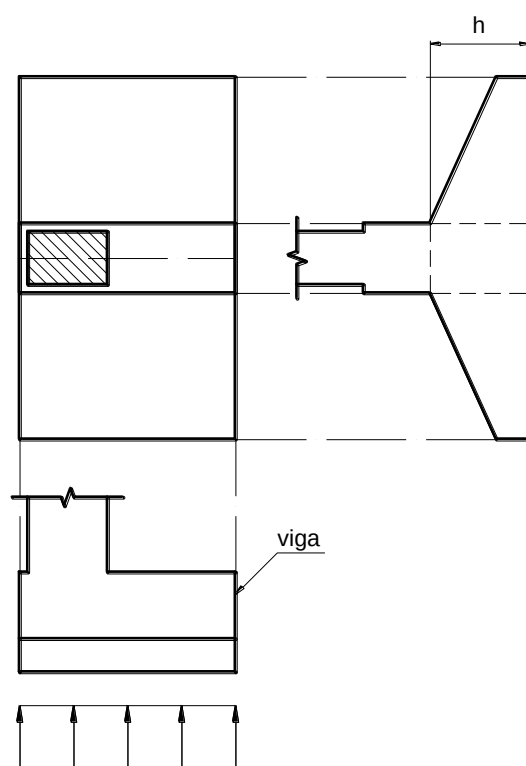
Sapata excêntrica na divisa com viga de reforço.
